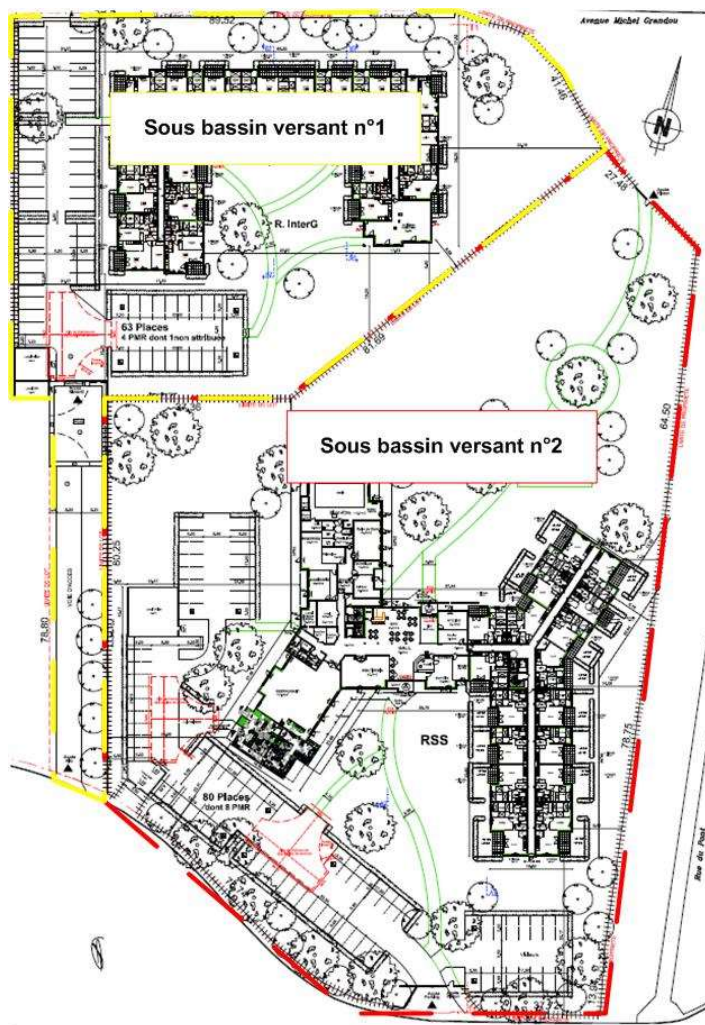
Schéma des BV du projet (source : plan masse du projet - ALAIN SALIN ARCHITECTE DPLG)
